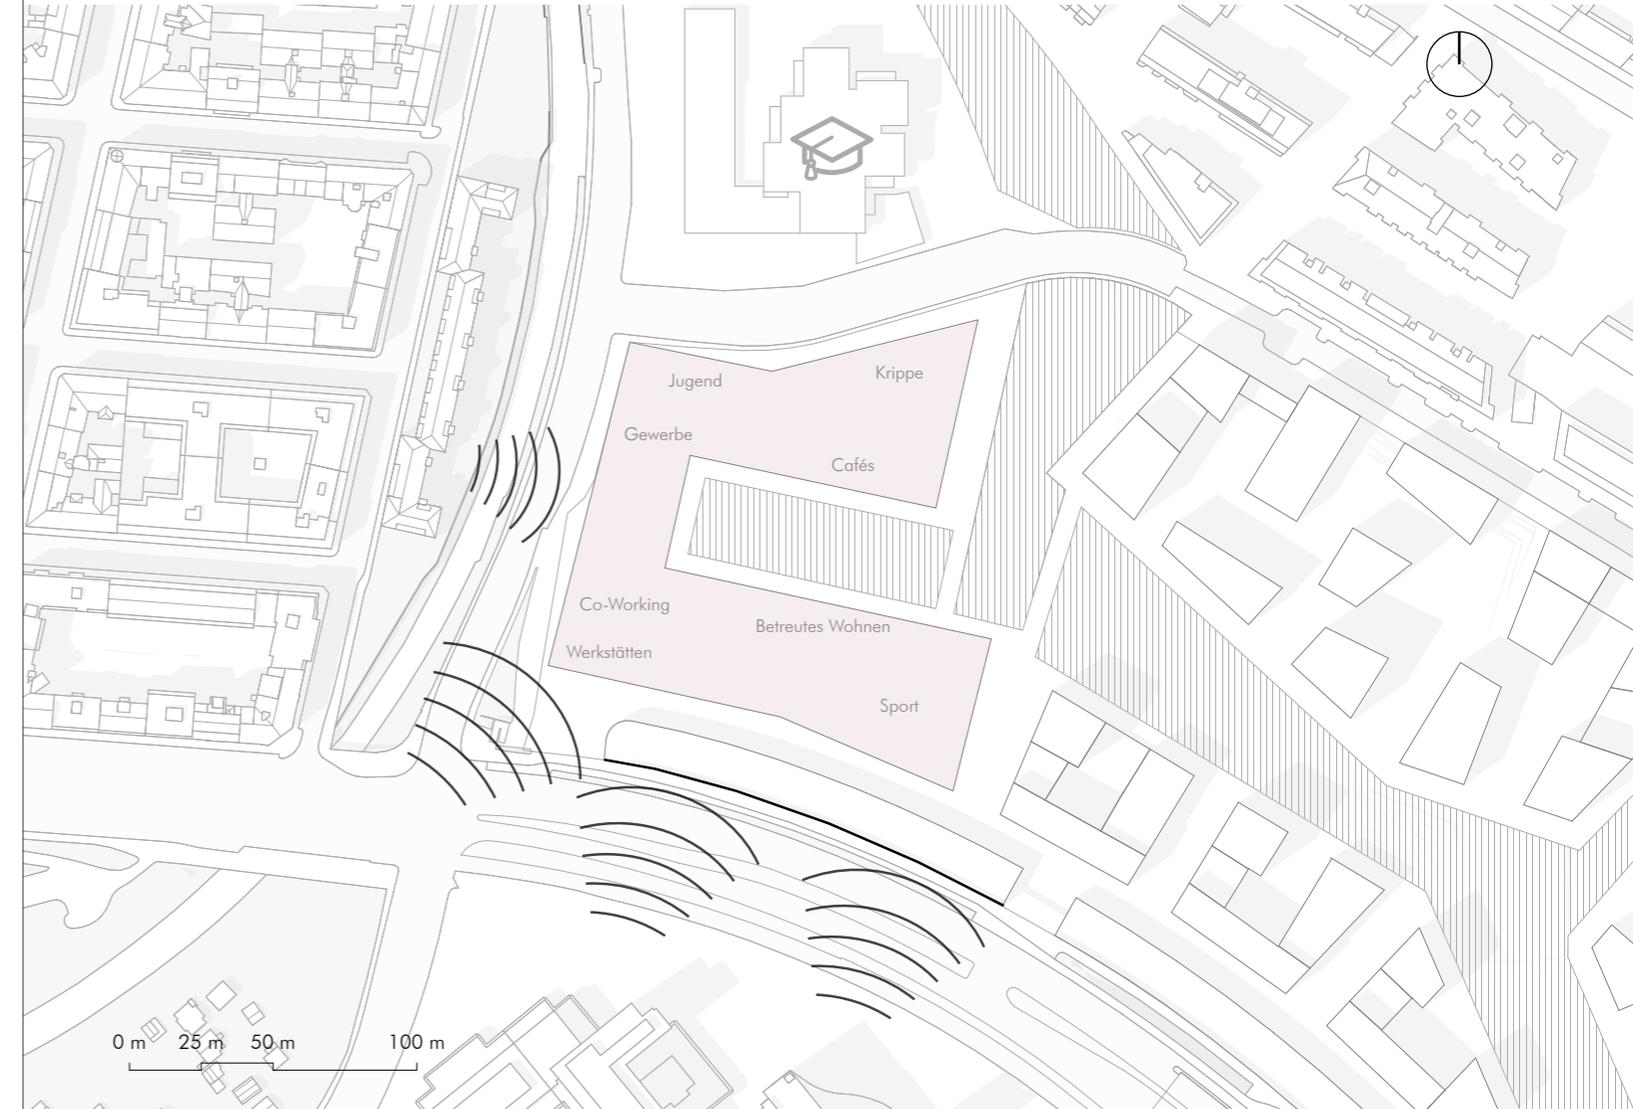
| Lageplan mit den Funktionsschema sowie Lärmquellen
